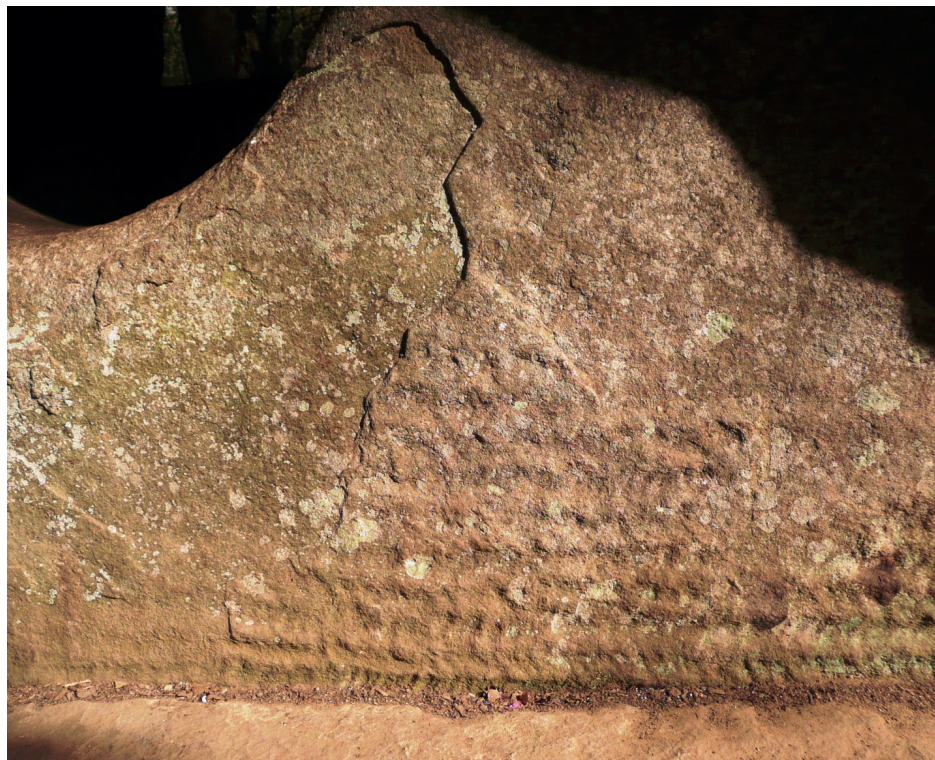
Отслаивание орнамента. Фрагмент фасадной стены
